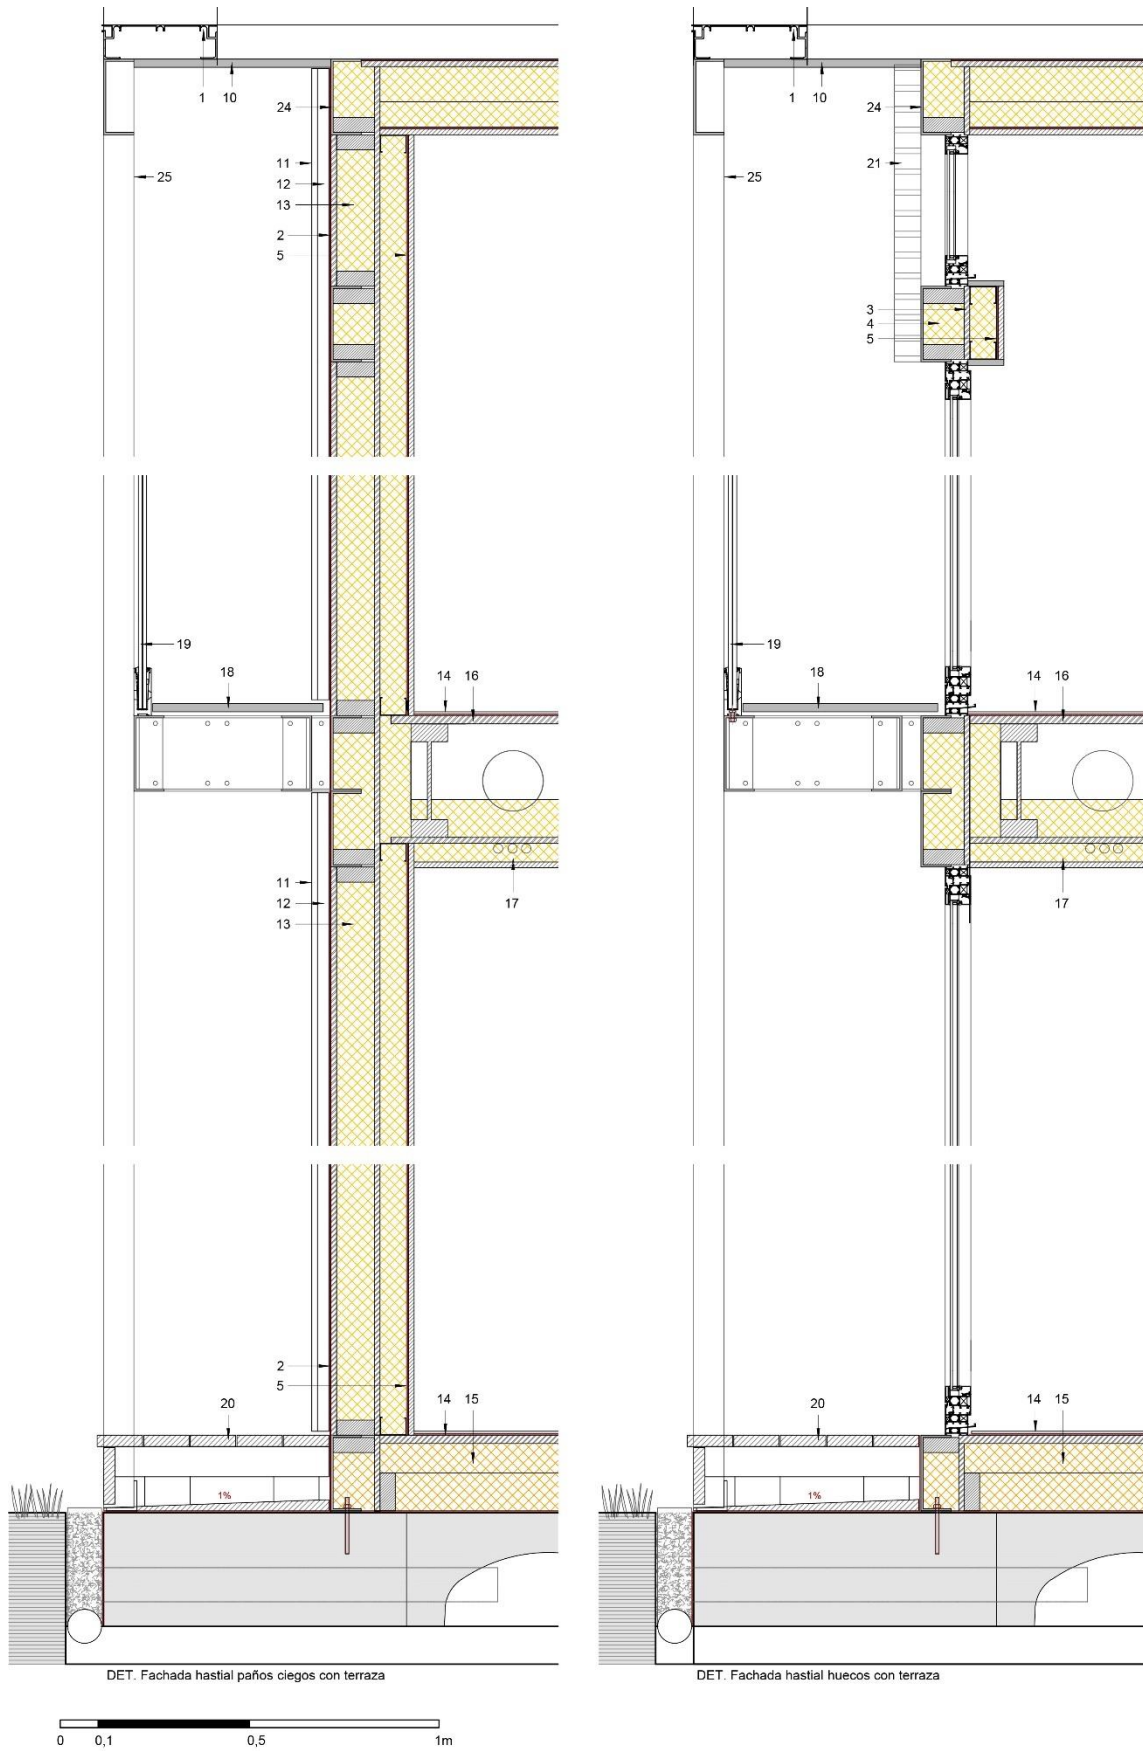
Detalles constructivos en fachadas hastiales. Fuente: Víctor Hermo Sánchez.
